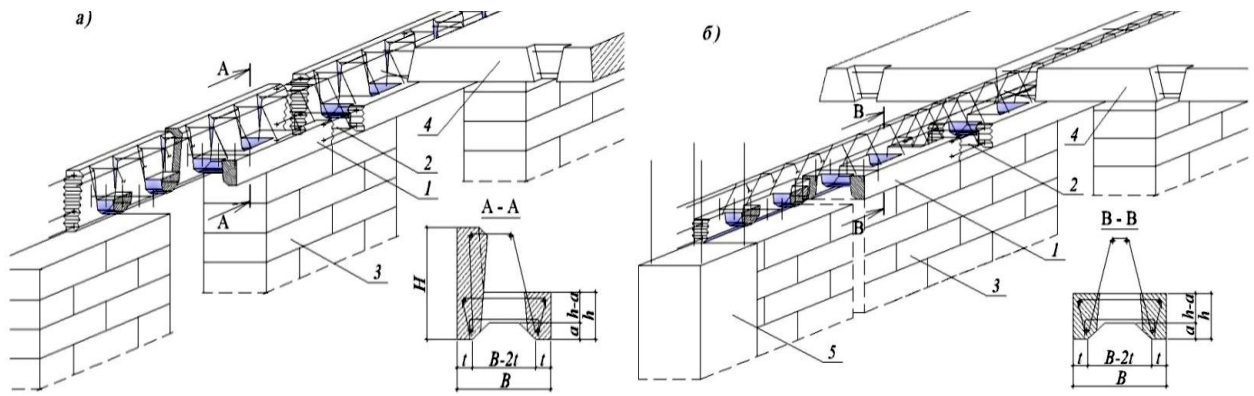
Сборный блок СбМт АС пояса в процессе монтажа наружных (а) и внутренних (б) стен здания: 1 - сборный блок с рабочим армированием и полостью для монолитного бетона, контактирующего со стеной площадью не менее 70 - 75% всей опорной площади пояса; 2 - стык сборных поясных блоков в середине простенка; 3 - стена; 4 - перекрытие; 5 - колонна [разработка автора].
